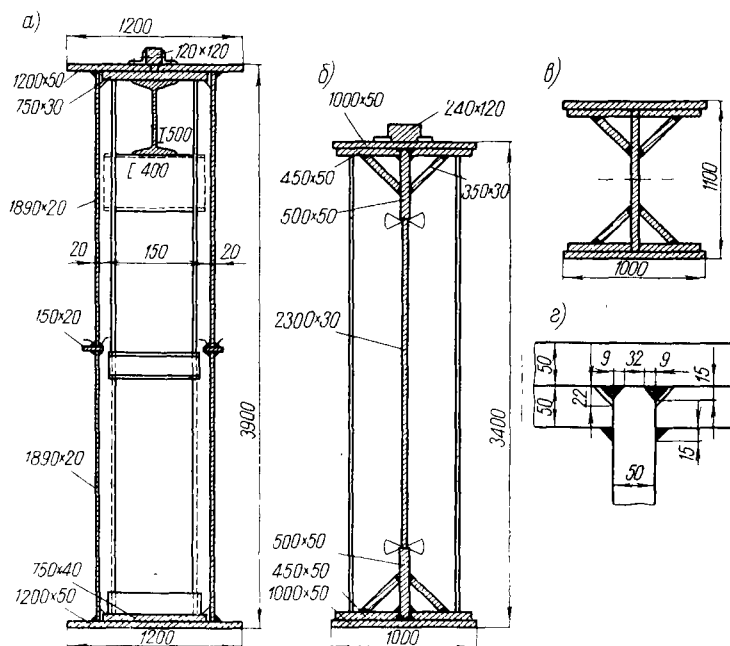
Сварные подкрановые балки для кранов грузоподъемностью 300 T (Чехословакия)
